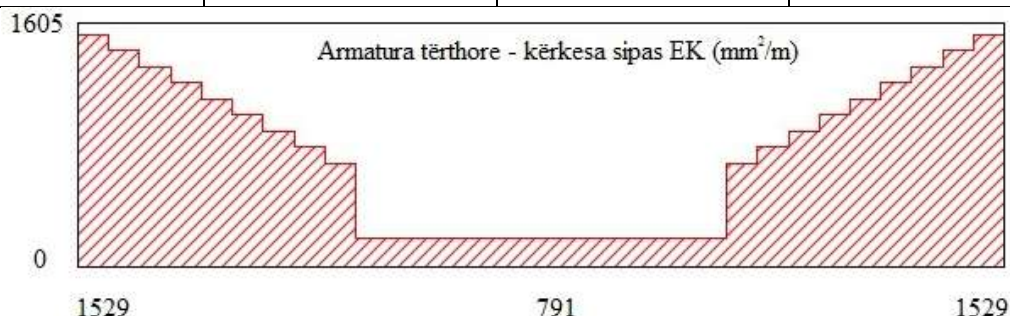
Kërkesa për armaturë tërthore sipas EK
